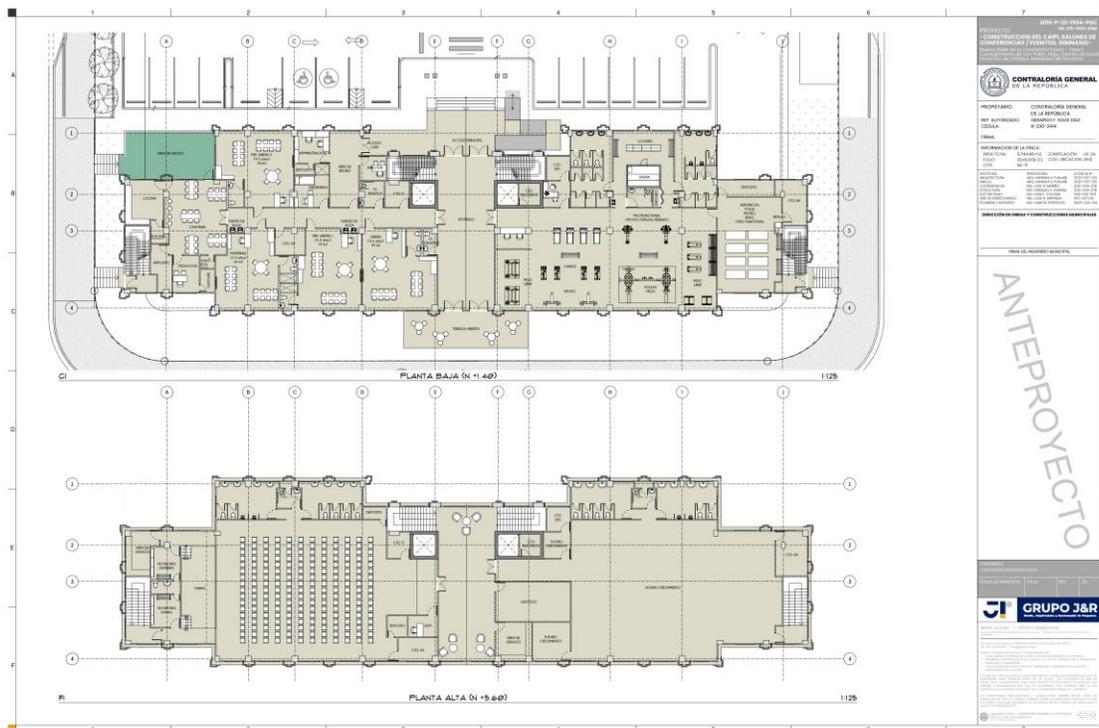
Vista de la Planta Arquitectónica Alta y Baja
